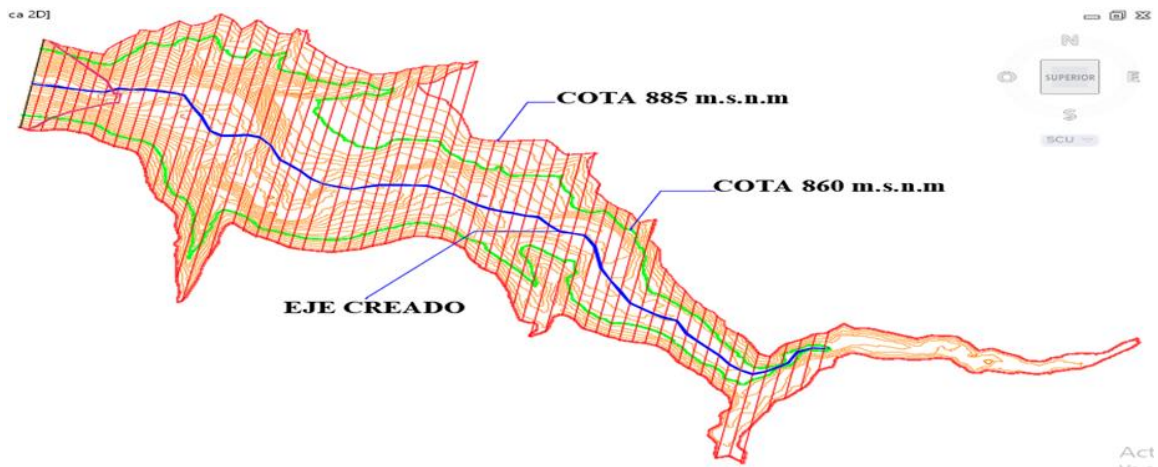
Secciones transversales usadas para la modelación hidráulica y de sedimentos del proyecto.
